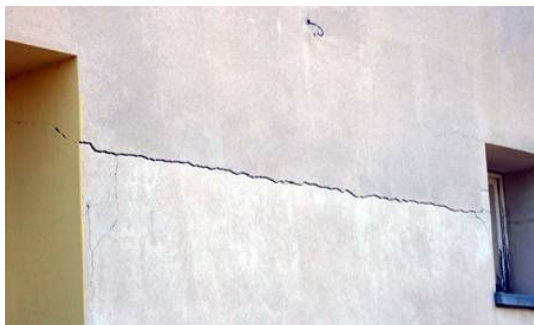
Fissuração orientada (A5) em parede exterior dupla de alvenaria de tijolo furado (Escola Secundária D. Sancho II).
